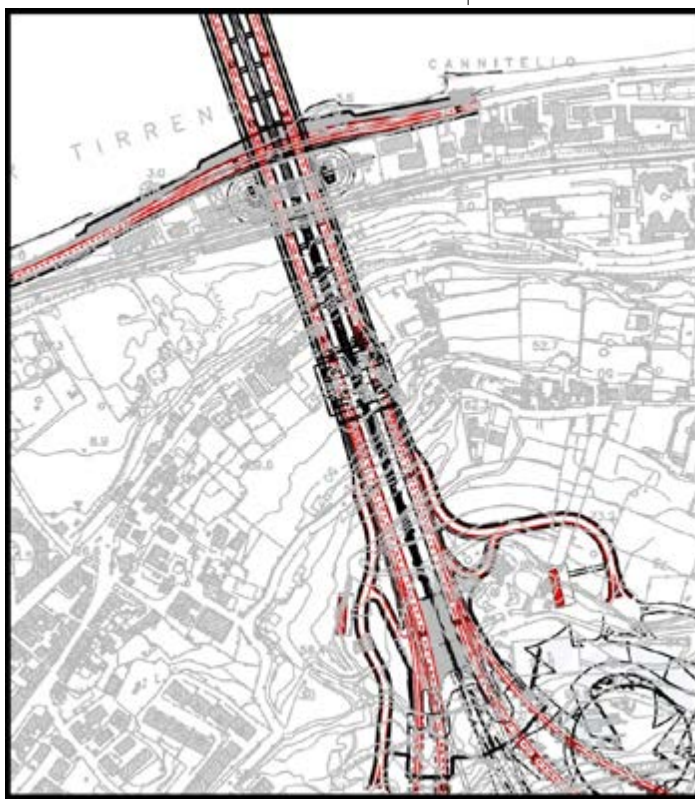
Planimetria generale sovrastruttura (stralcio tavola PG0001 del progetto definitivo)
